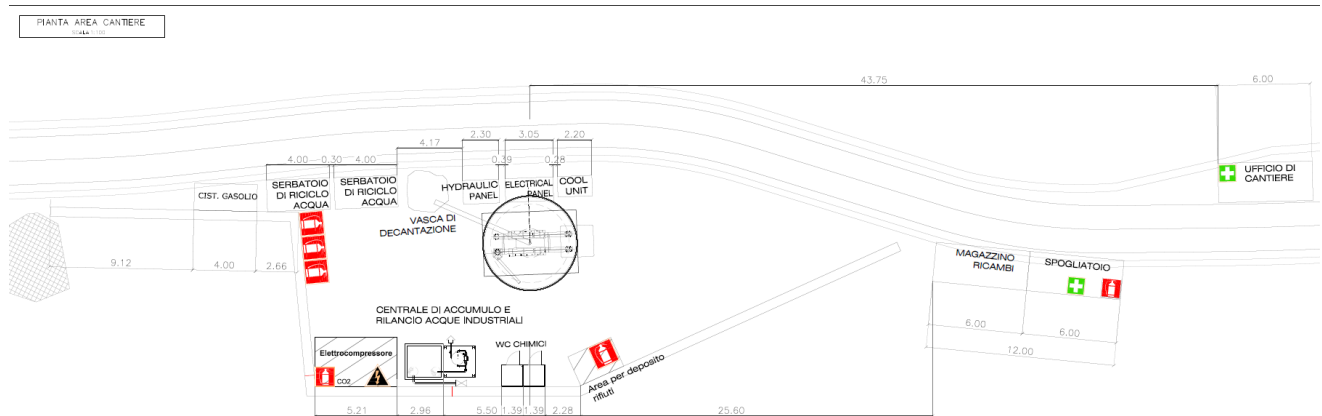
Cantiere pozzo: fase 1 – scavo con rise boring
